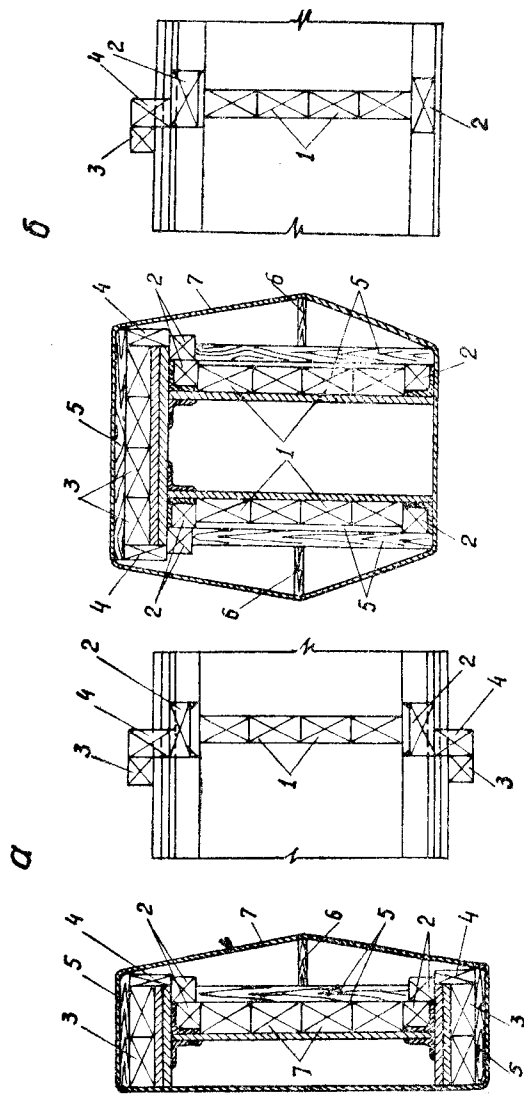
Подорывание стальных балок фигурными зарядами: а — балка двутаврового сечения; б — балка коробчатого сечения; 1 — заряды на стенках; 2 — заряды на полках; 3 — заряды на углах; 4 — соединительные шашки; 5 — дощатые накладки; 6 — распорки; 7 — проволочка или веревка
